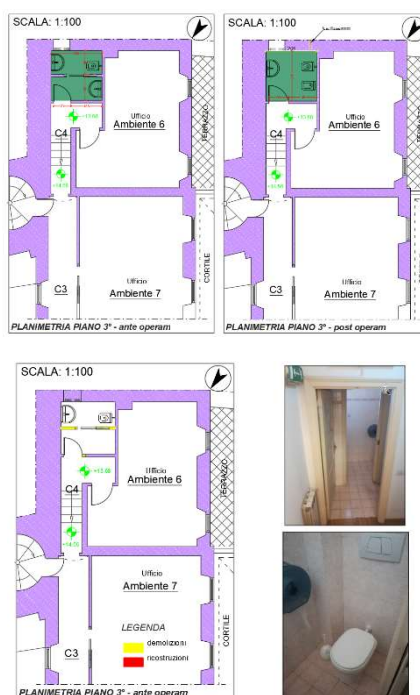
Planimetria piano terzo Palazzo Ossoli: servizio igienico da rinnovare
